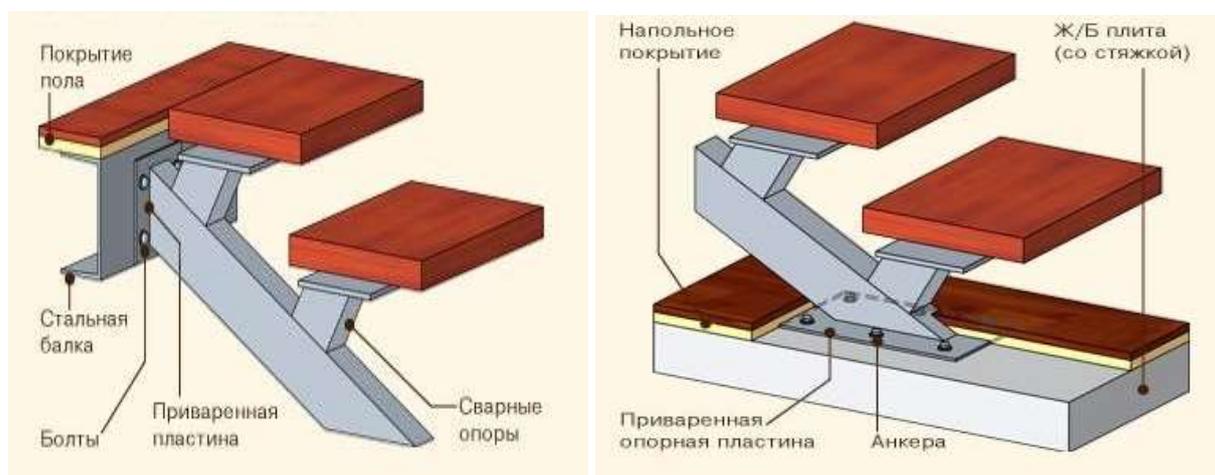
Узлы крепления лестницы с деревянными ступенями и металлическим косоуром: а – крепление стального косоура к балке; б – опирание стального косоура на железобетонную плиту.
